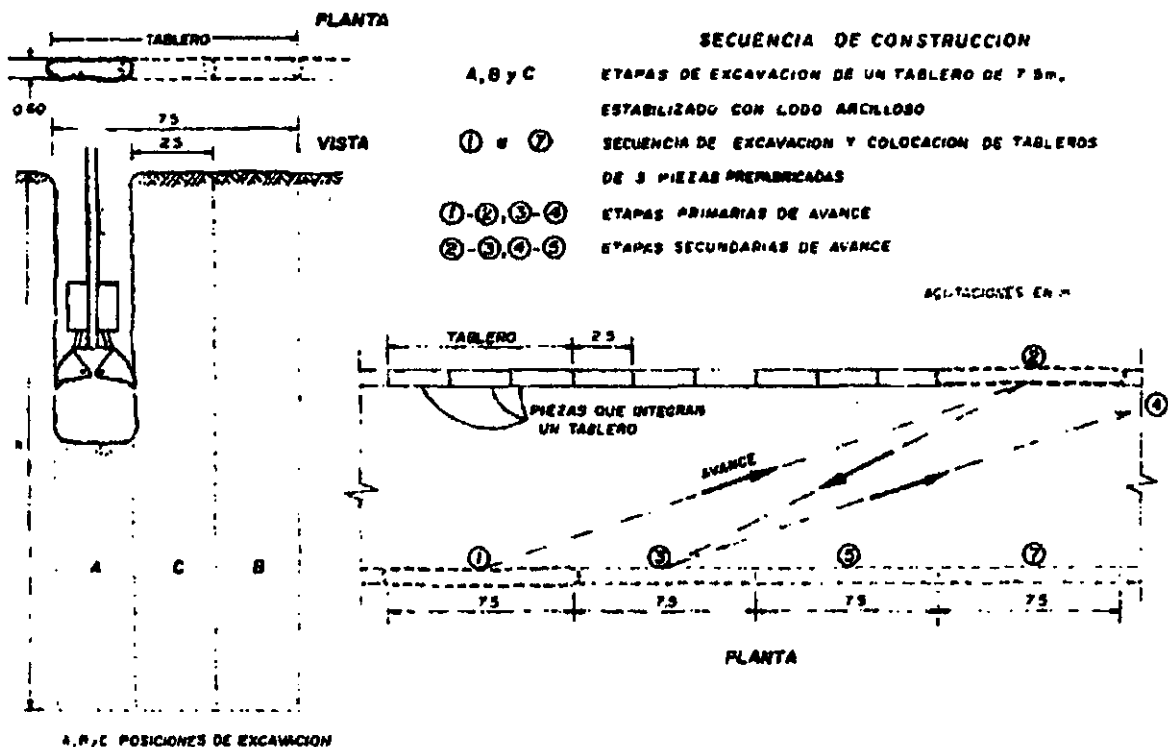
Procedimiento de excavación y colocación de los muros prefabricados con avance modular.
